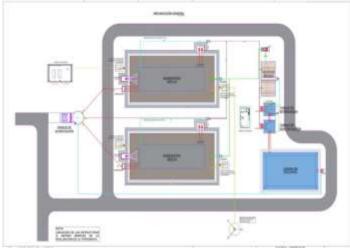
Plano de estructura interna de la planta de generación de biogás
